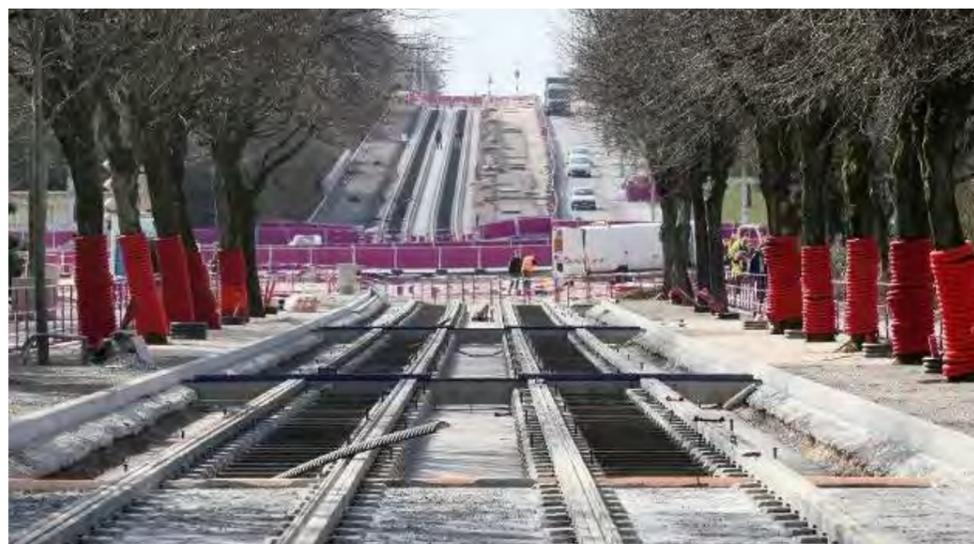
Travaux de construction de la plateforme du Tramway – Dijon
